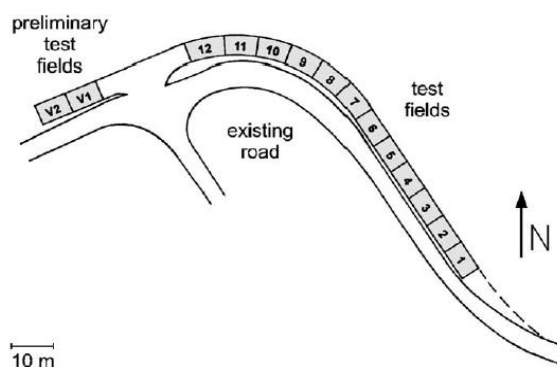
Layout da faixa de teste com divisões entre o campo de teste [16].
